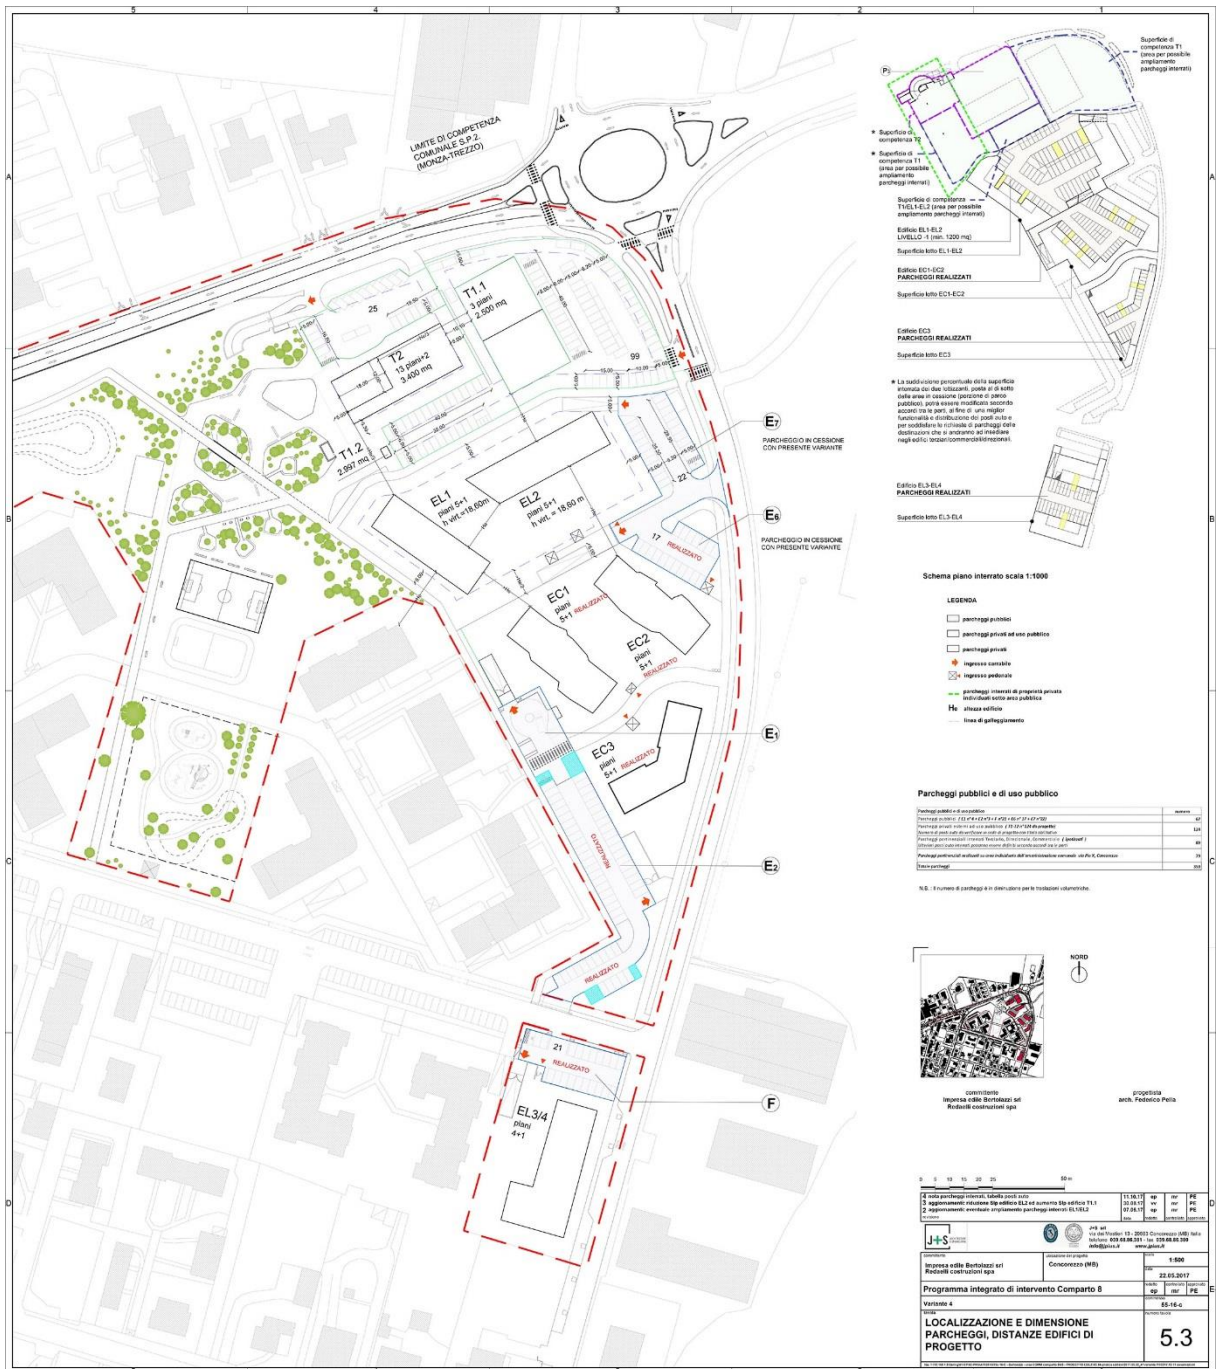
Estratto Tavola 5.3 Variante 4 alla convenzione di PII
